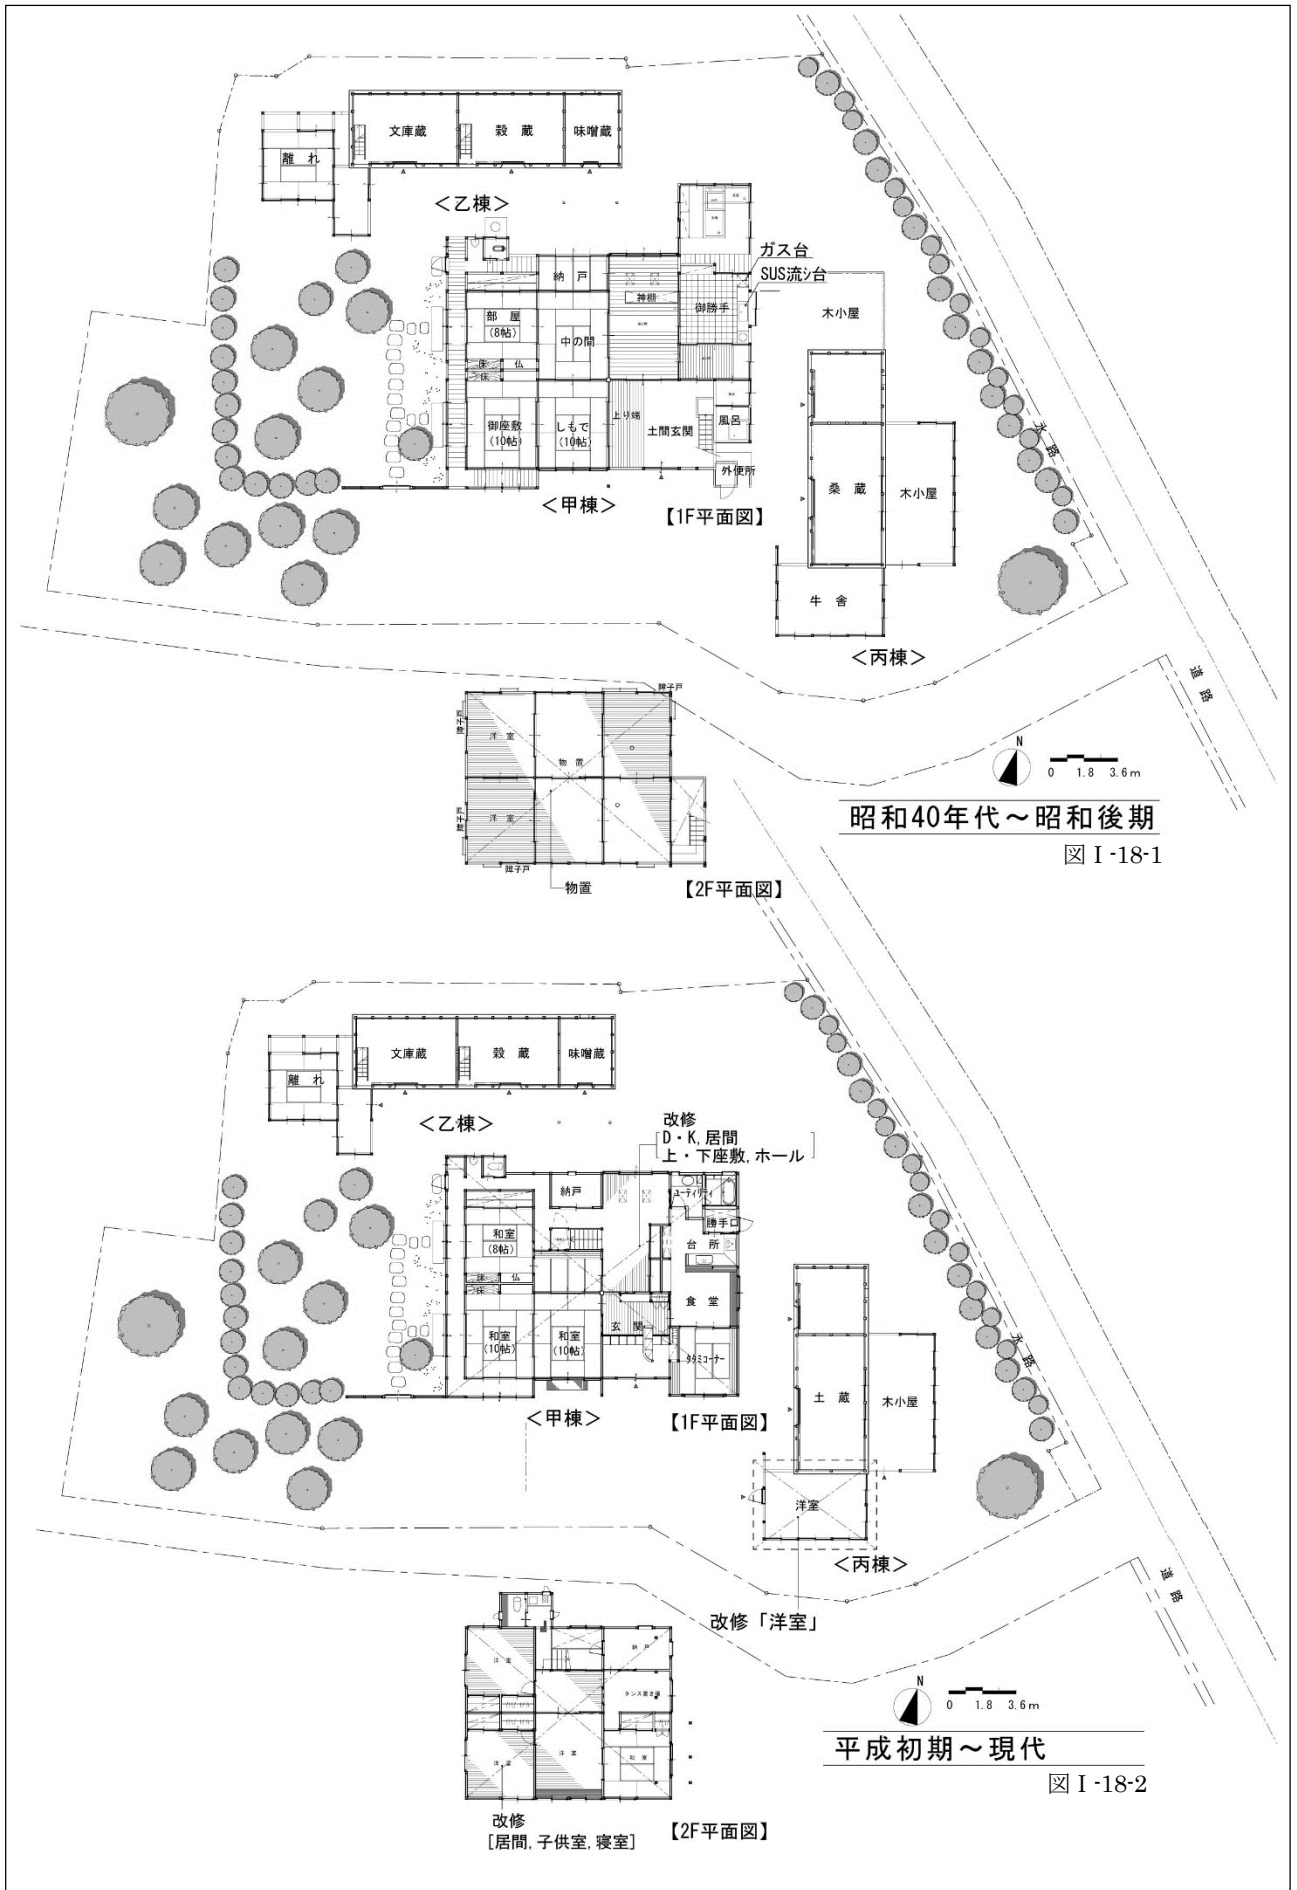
養蚕民家・Ki邸 改修履歴平面図(2)
